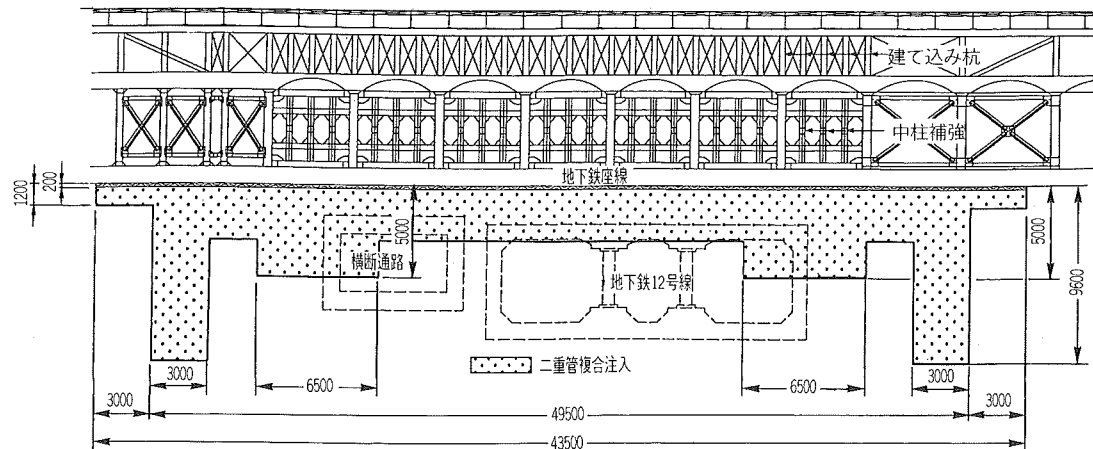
中柱補強・薬液注入・建て込み杭施工位置図
